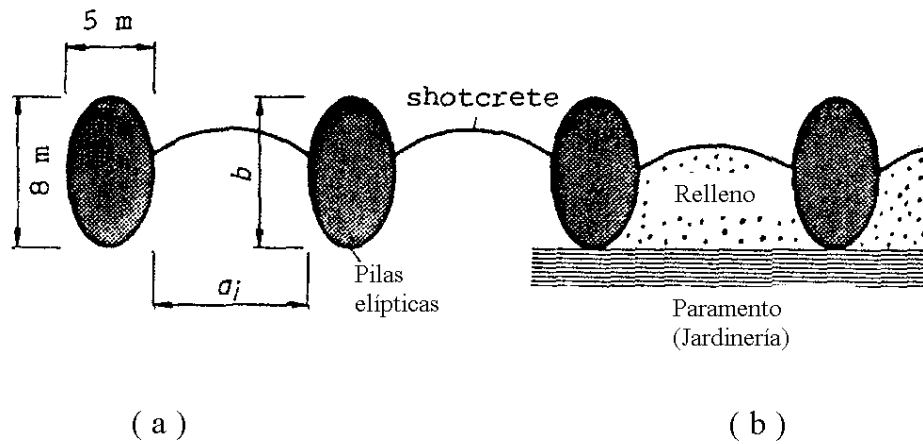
Diagrama esquemático en planta, de distribución de pilas (Brandl, 1988).
